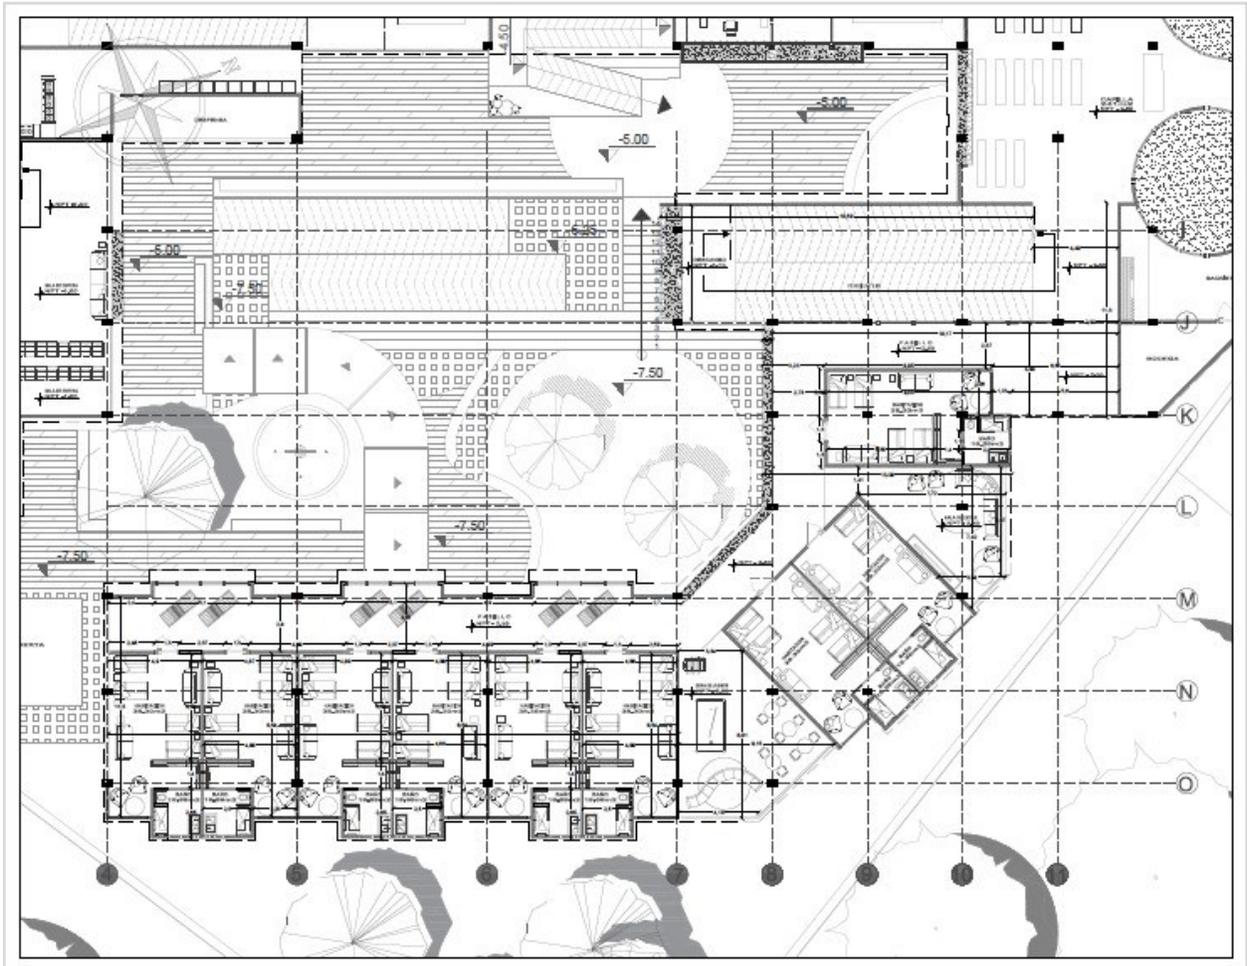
Planta 0 Edificación 3 (Rubiano, 2020)
